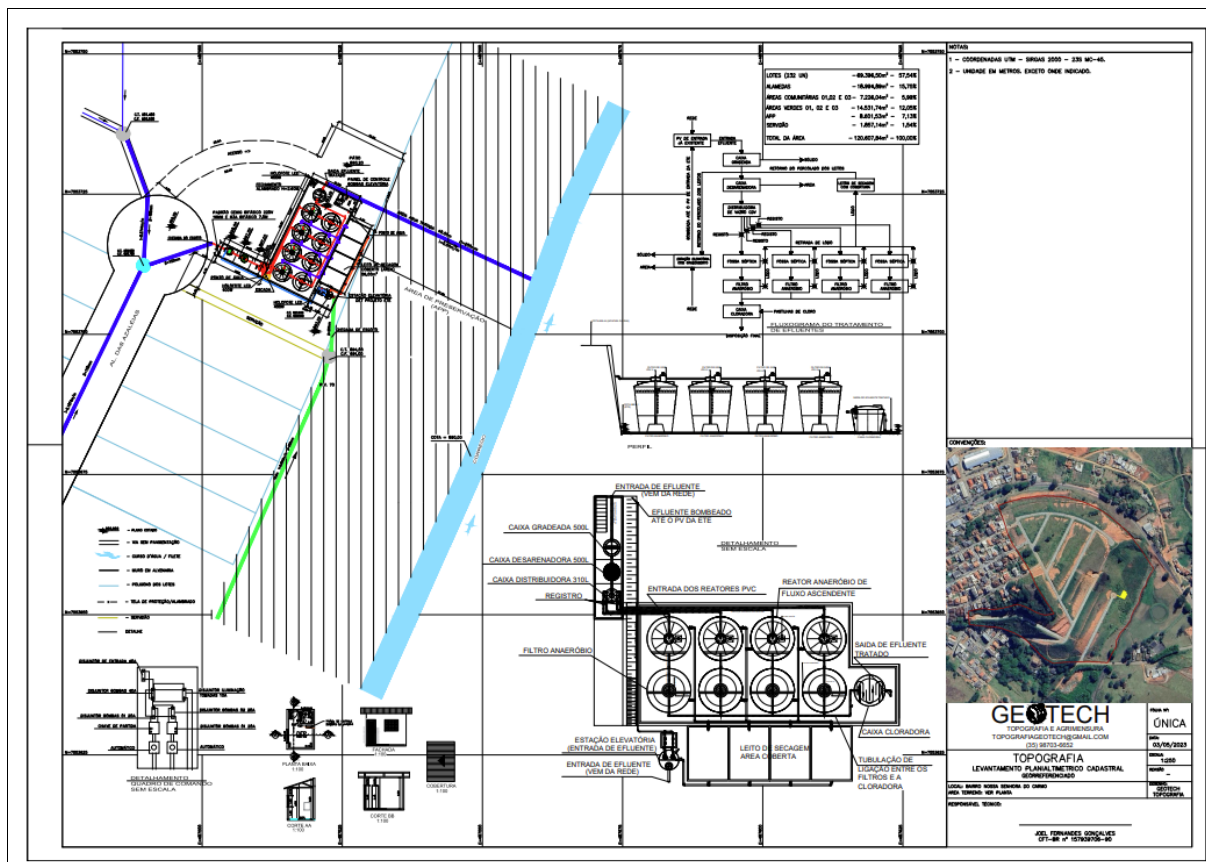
Planta georreferenciada do empreendimento. Fonte: SLA.
